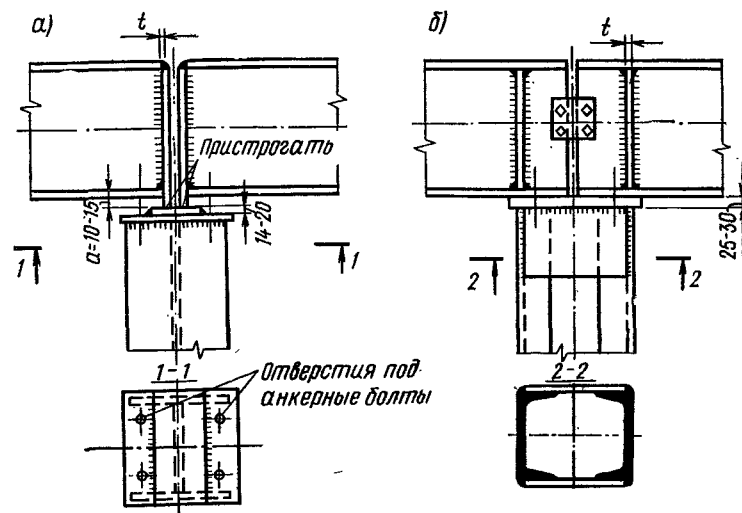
Варианты (а, б) опирания балок на оголовки колонн
